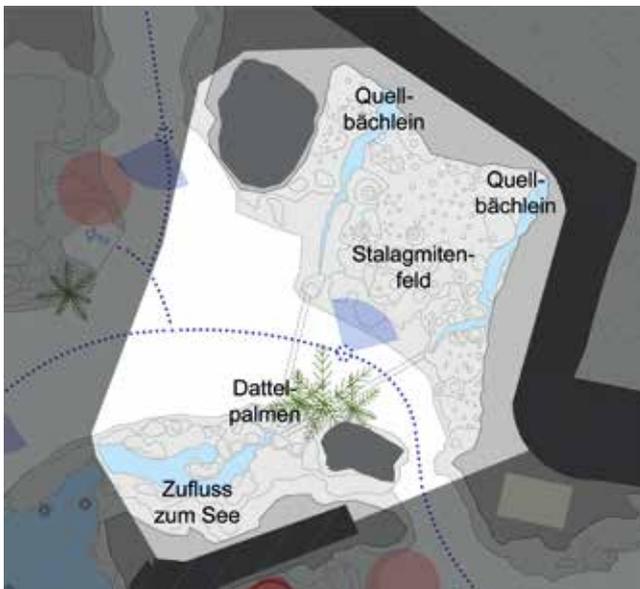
Grundriss und dreidimensionale Ansicht des Stalagmitenfeldes mit Quellbächlein am Eingang zur Hauptgrotte
